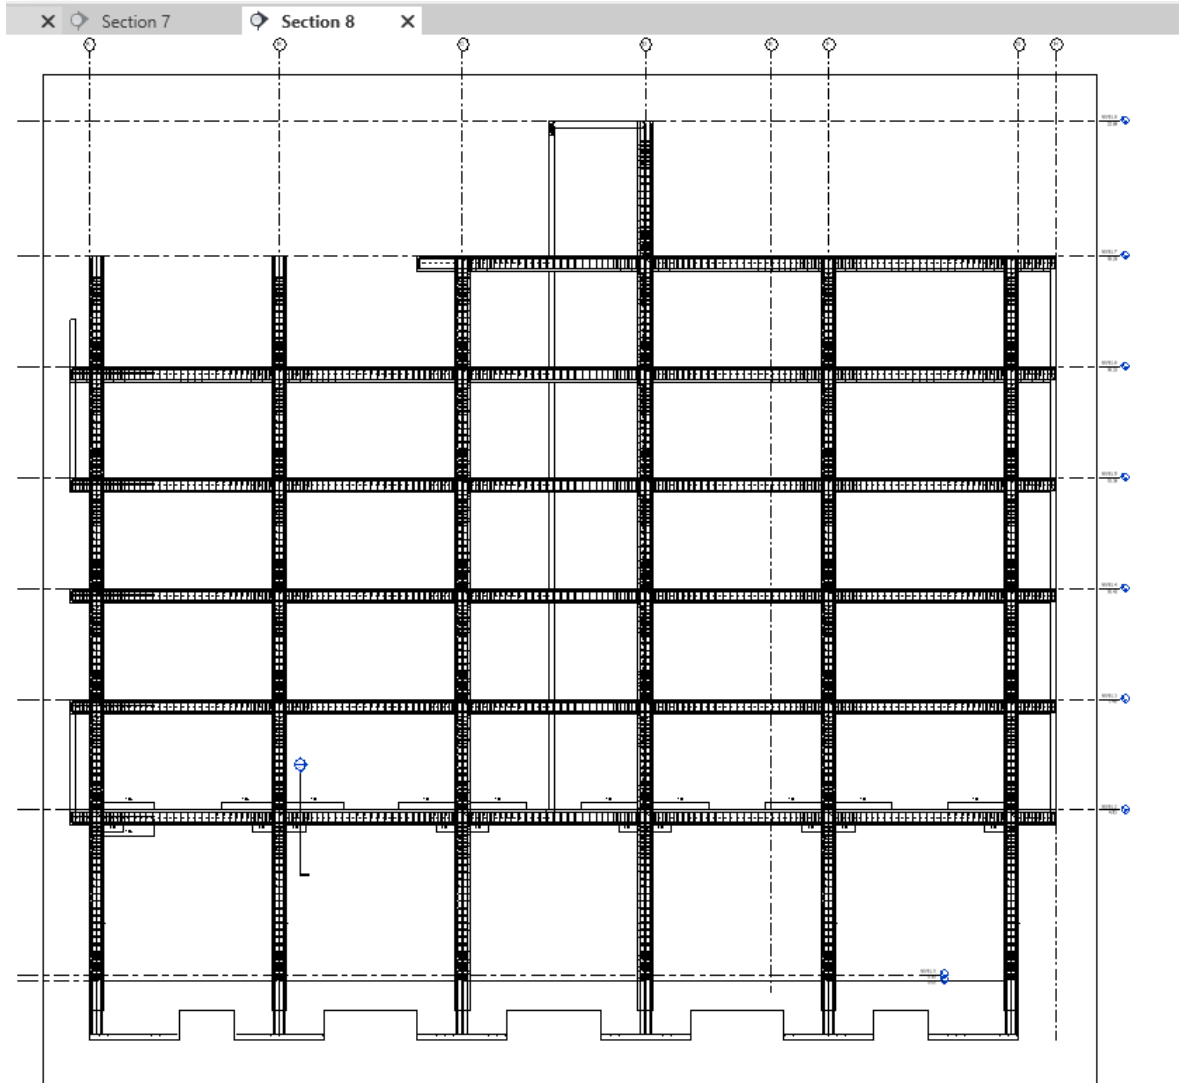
Vista Corte de distribución de acero en Viga V-P1 y V-A100 en Proyecto
